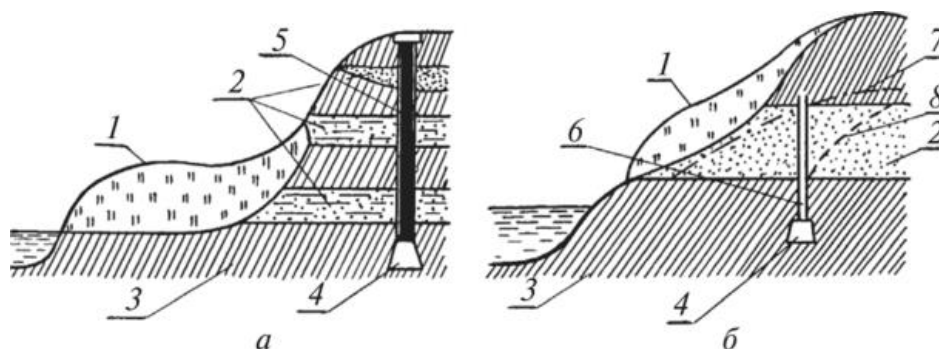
Схемы перехвата грунтовых вод (осушение откоса):
